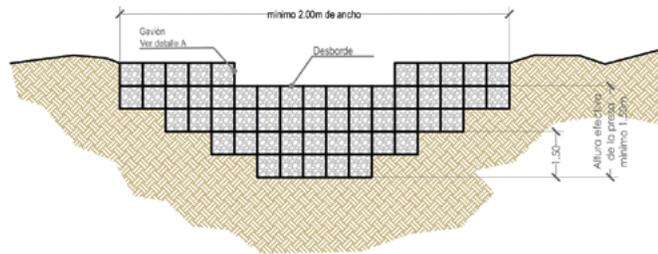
Detalle Constructivo de Presas Filtrantes.
